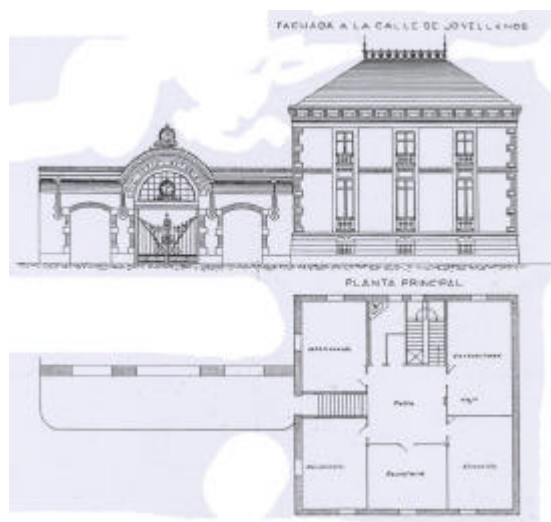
Estación de Oviedo. Fachada modernista a la calle de Jovellanos y planta principal del hotel de oficinas, 1905.
